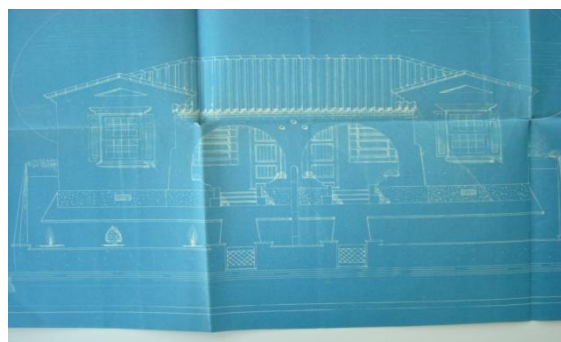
Imagens recentes e fachada de casa do tipo “vila”
